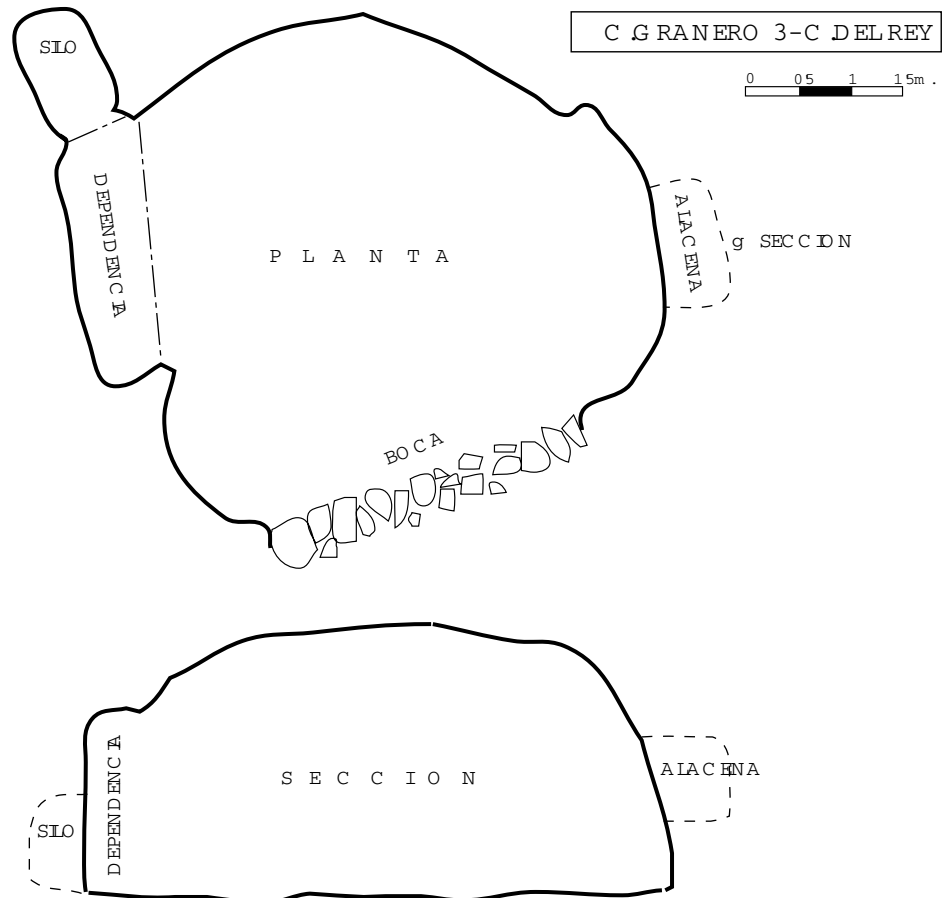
C GRANERO 3-C .DEL REY: PLANTA Y SECCION DE LA CUEVA. En la boca de la cueva hay un pequeño muro de piedras, que no sobrepasa el metro de altura.
